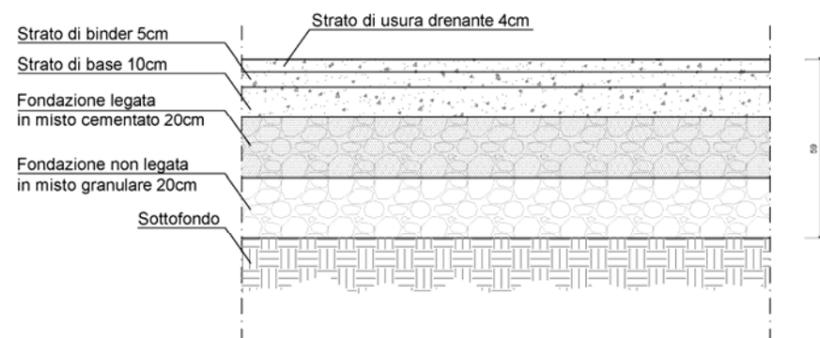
Riquilifica margine interno - PAVIMENTAZIONE TIPO 2
